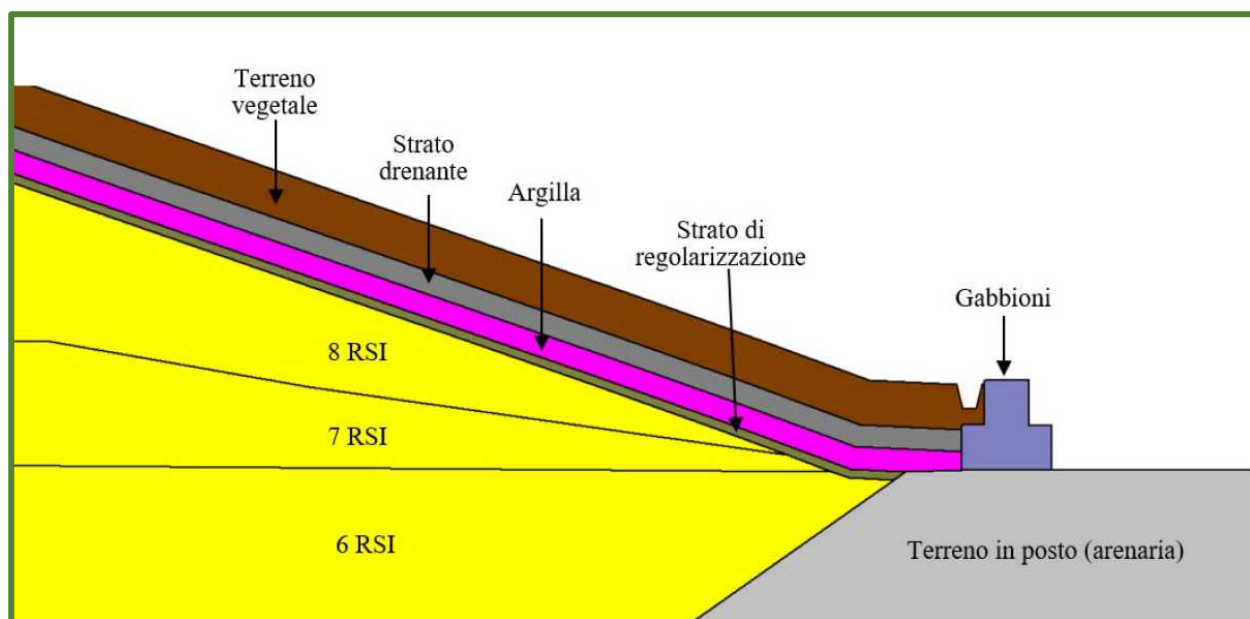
/IX – Sezione B-B'' – Particolare 2
